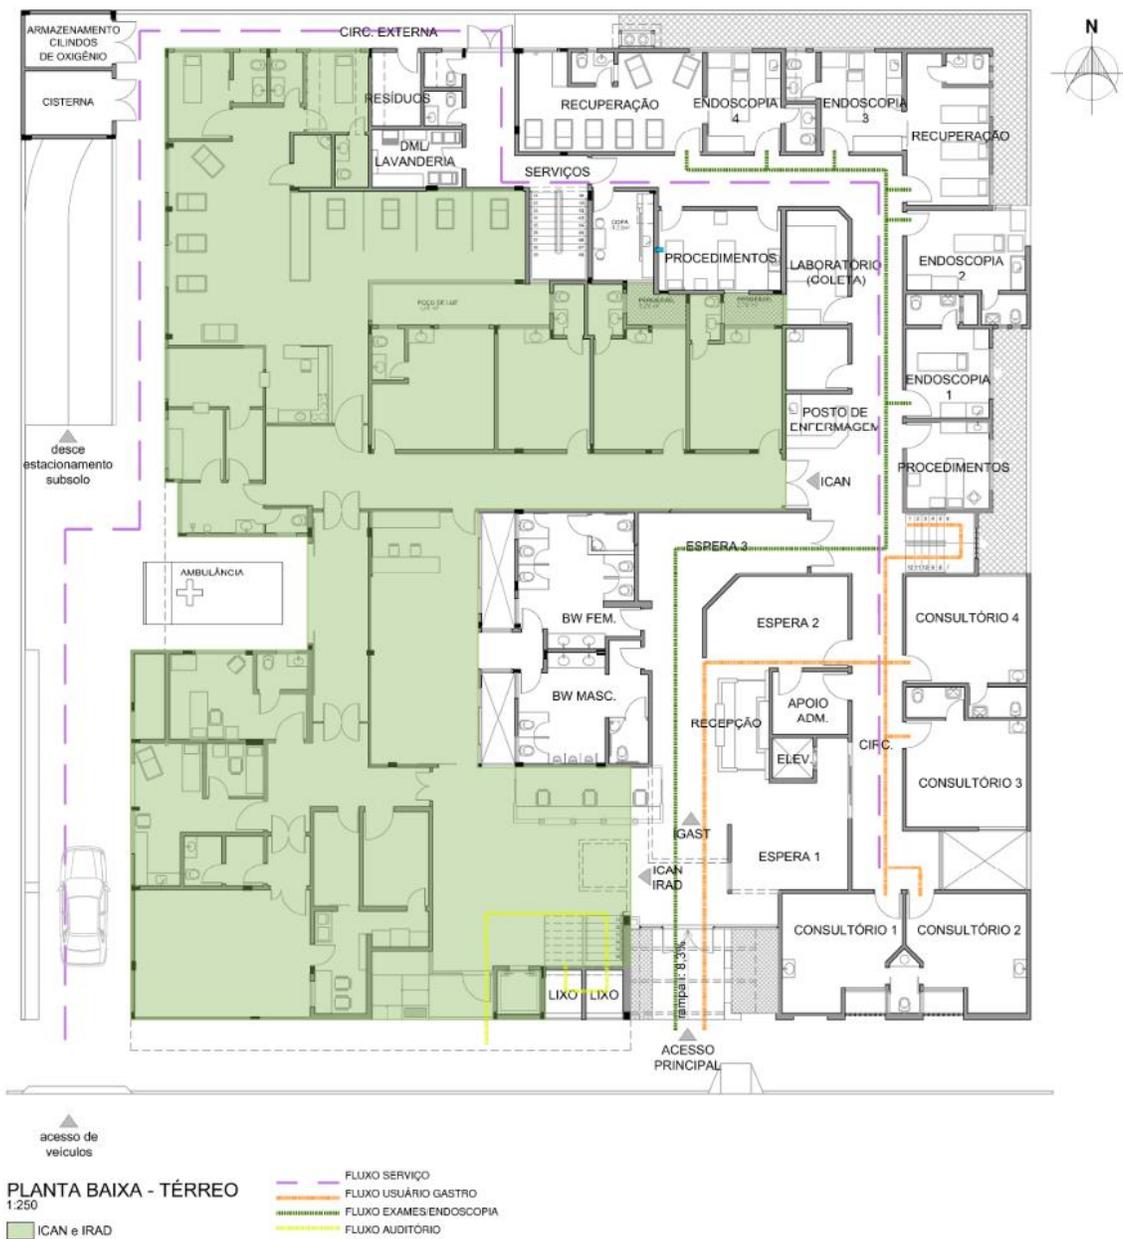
Planta do pavimento térreo do IGAST, Toledo PR.
